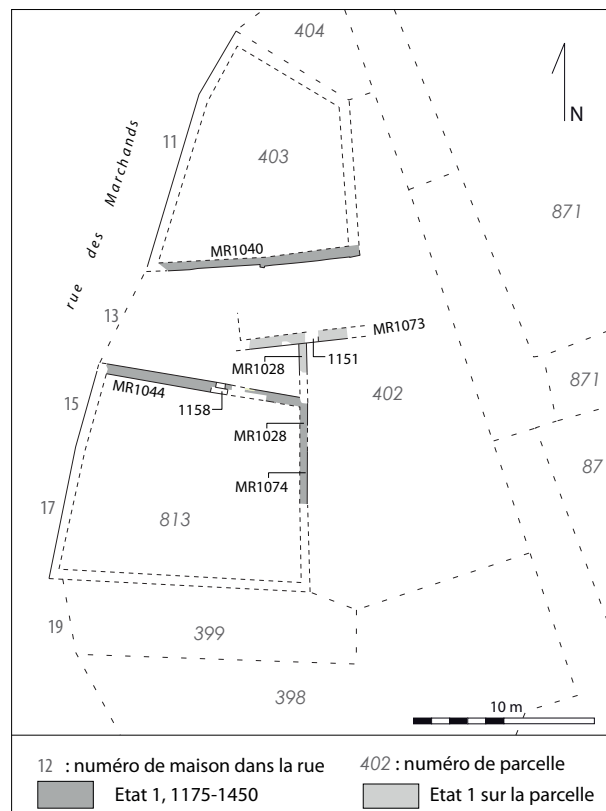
Les vestiges bâtis les plus anciens sur la parcelle. Plan du rez-de-chaussée (état 1, avant 1450 environ) sur fond de plan cadastral actuel
